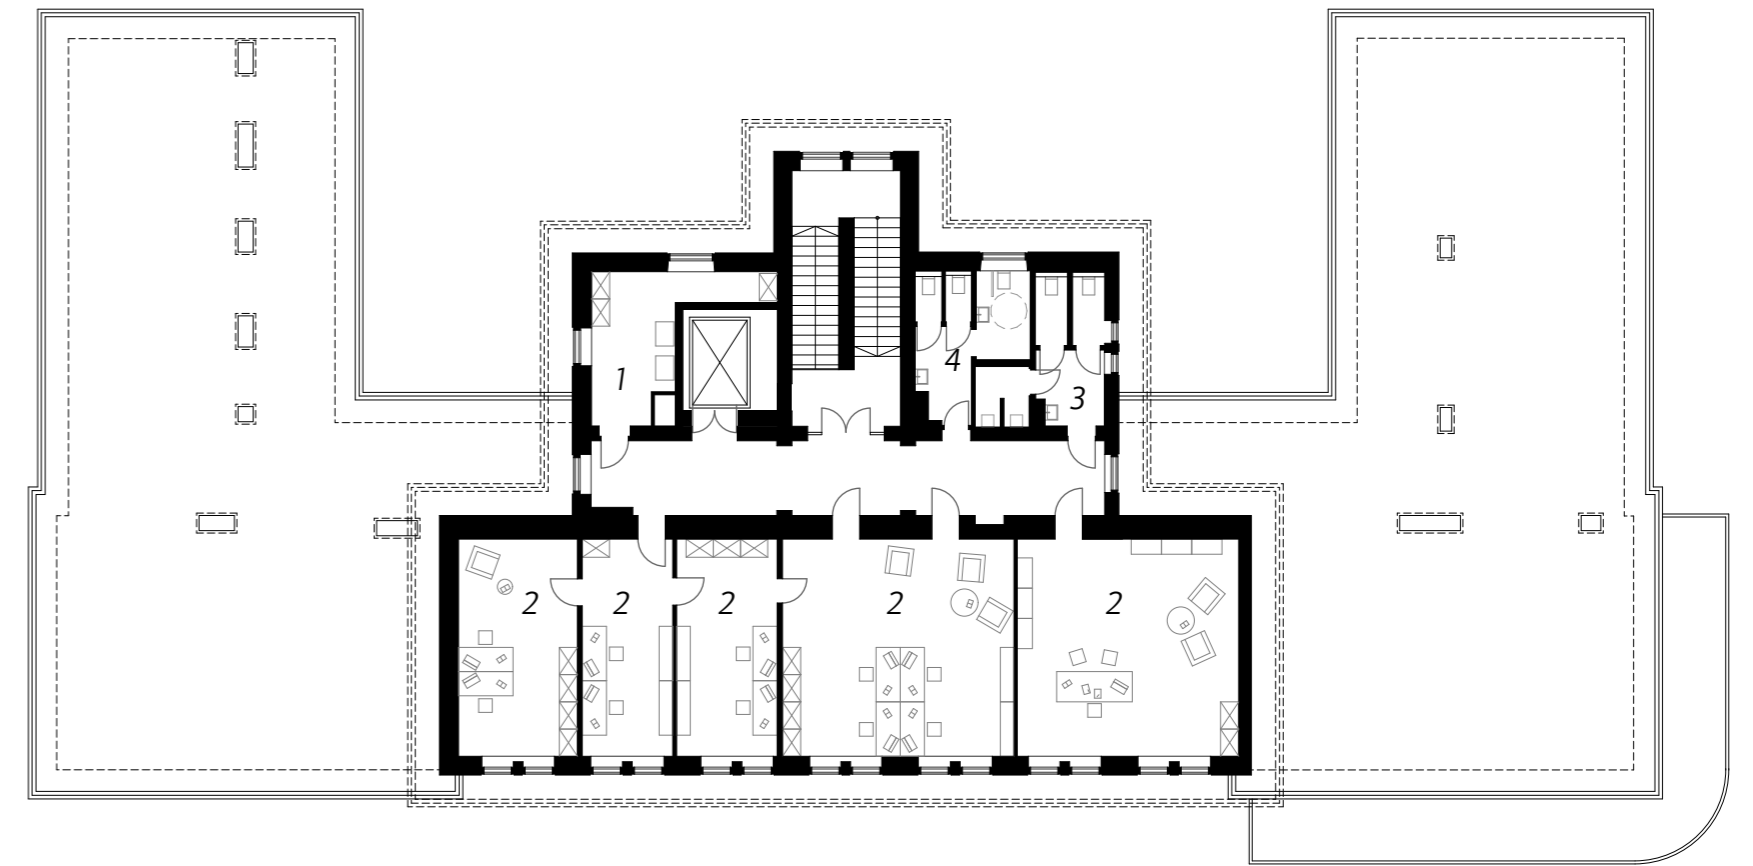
Umbaumaßnahmen Pavillon 4 | 2.Obergeschoss | M 1-250
